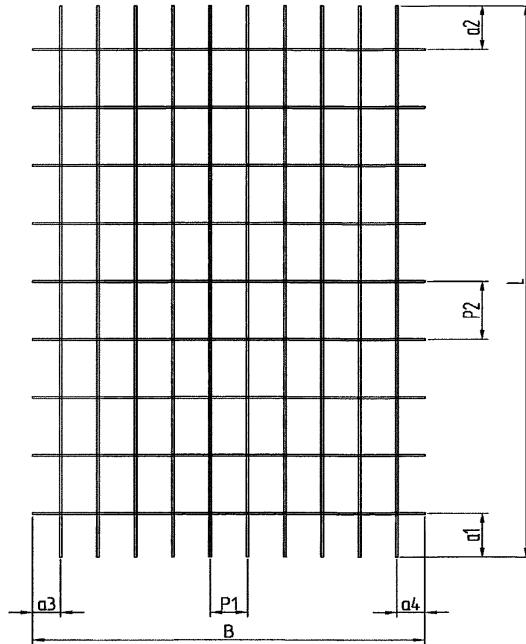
Арматурный элемент против продавливания для приопорных зон безбалочных перекрытий
